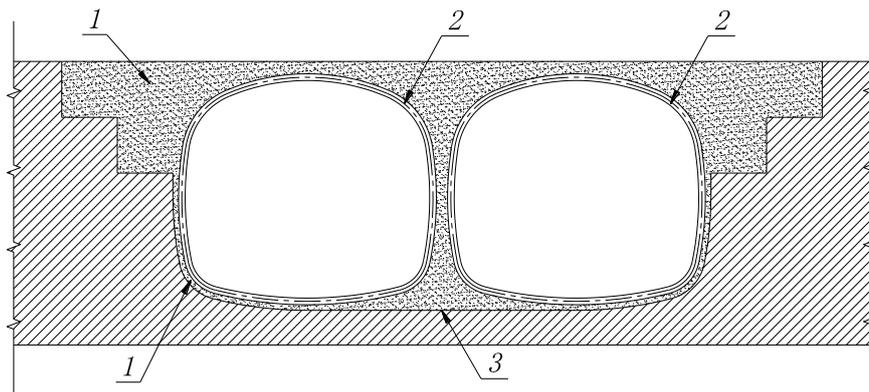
多孔箱型横断面螺纹钢管涵洞示意图
